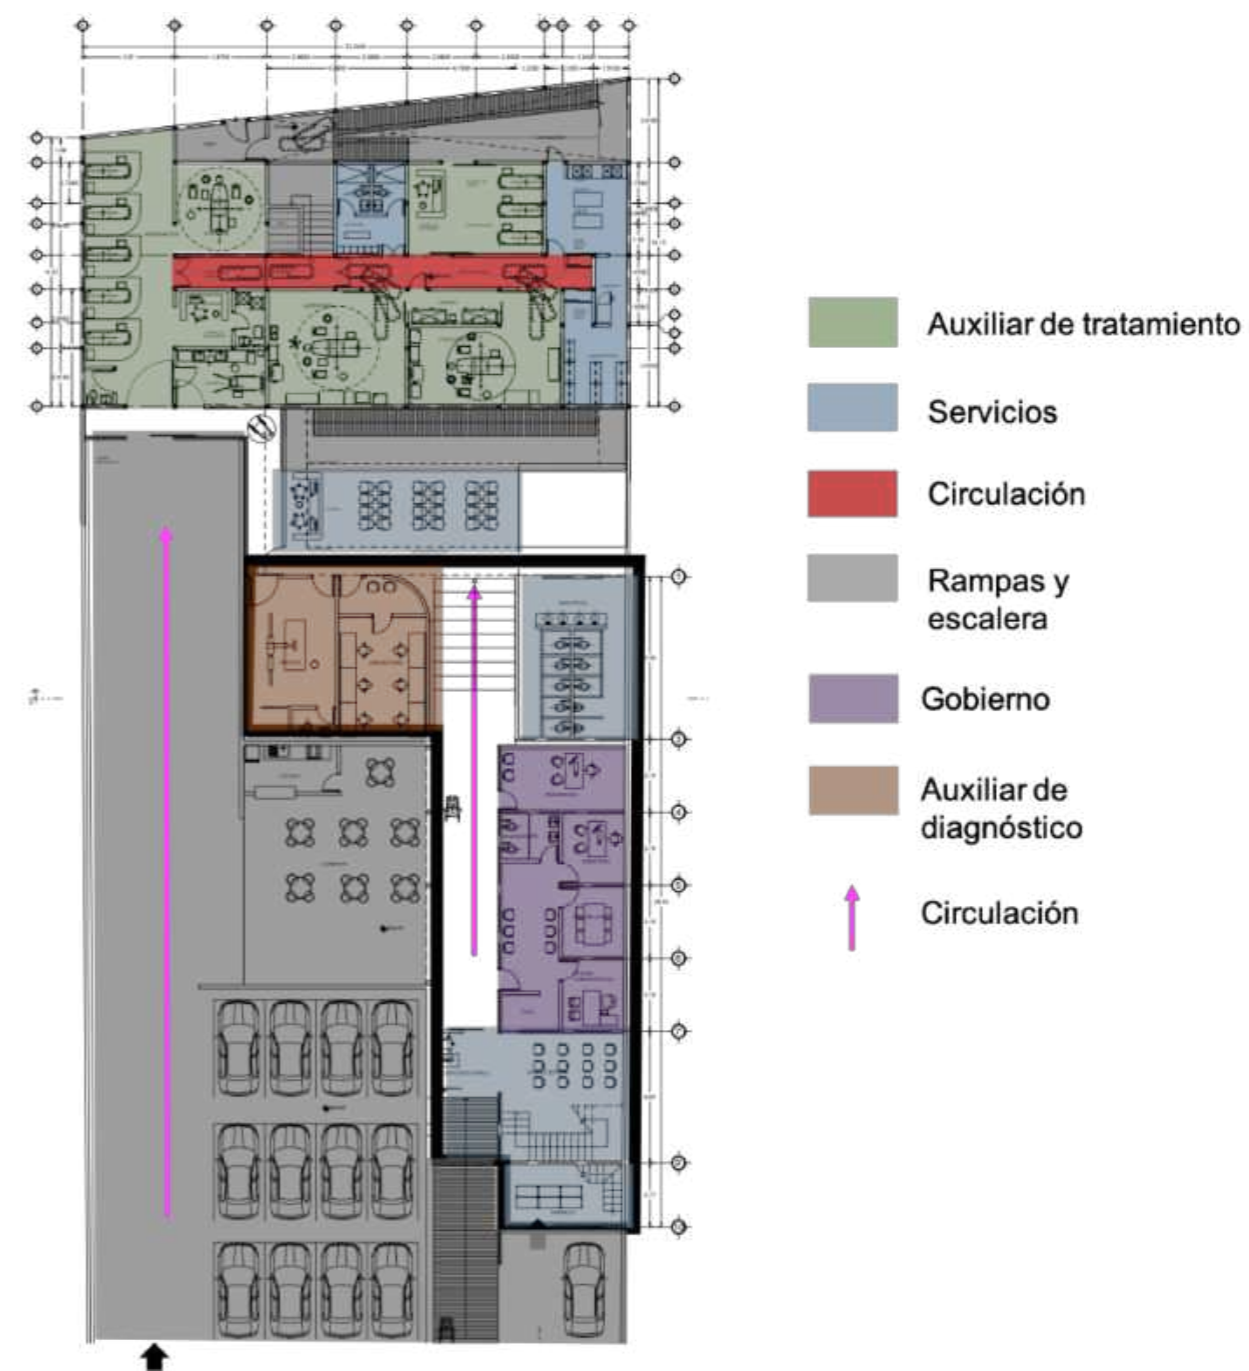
Distribución de espacios en edificio remodelado y ampliación en planta baja. Fuente: Elaboración propia
